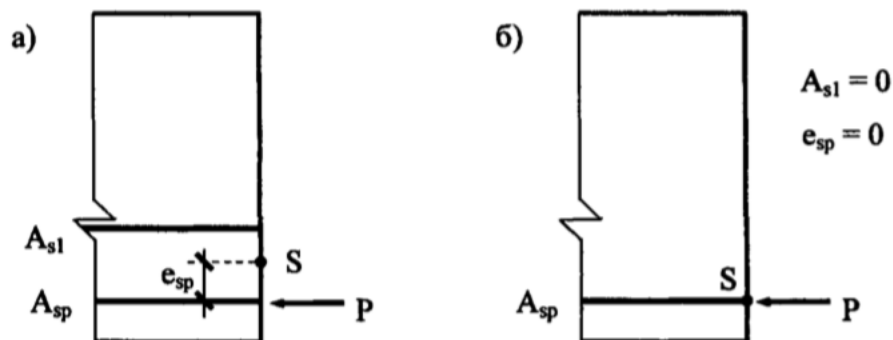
К определению величины  $e_{sp}$ : а) конструкция с двухрядным расположением арматуры по высоте сечения; б) конструкция с однорядным расположением арматуры по высоте сечения; S – центр тяжести площади поперечного сечения всей растянутой арматуры
